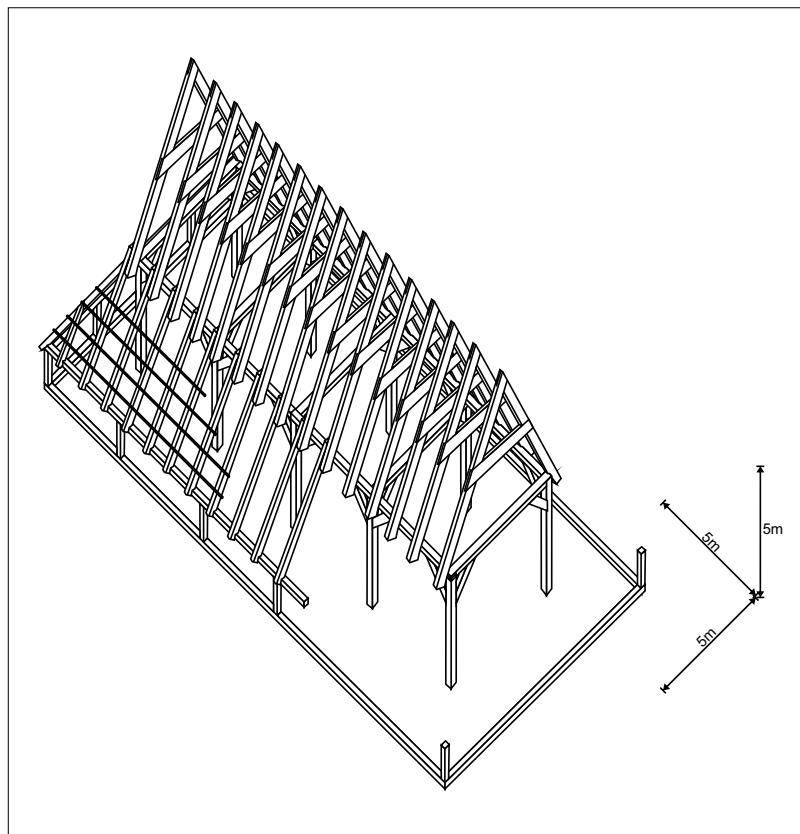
Rekonstruktion des Ihlower Gründungsbaus. Sollte sich das Dormitorium in diesem Gebäude befunden haben, ist ein ausgebautes Dachgeschoss anzunehmen.
